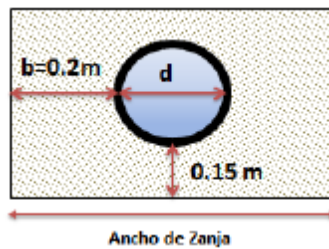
Ancho de Zanja según Manual Técnico para Alcantarillados Novafort y Novaloc. Tomado de PAVCO
